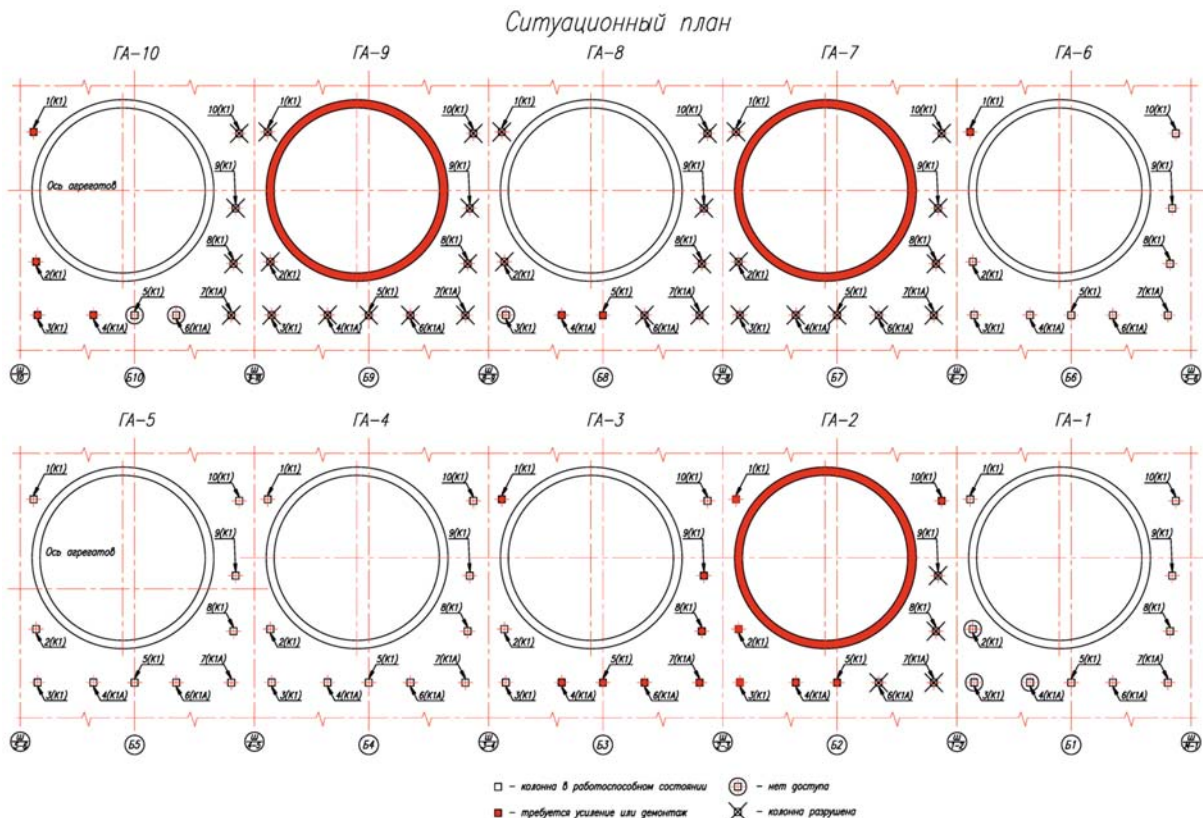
В результате аварии были разрушены монолитные железобетонные перекрытия на отм. 327,0 м у ГА-2, ГА-7 и ГА-9, колонны под монолитными перекрытиями этих агрегатов и стены кольцевых шахт генераторов
